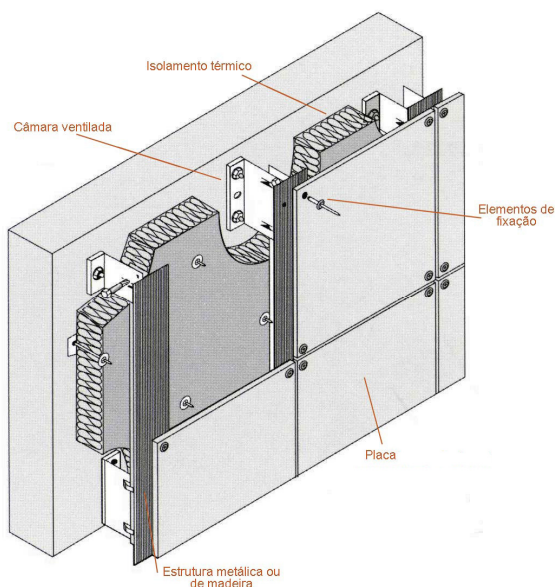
Esquema da constituição de uma fachada ventilada [46]
